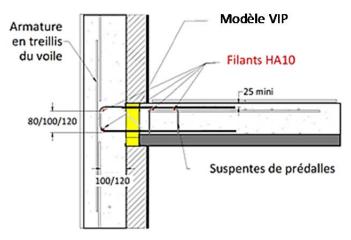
Coupe plancher à prédalle/façade (Rupteur VIP) (le doublage est réalisée selon les prescriptions de l'Annexe 9)
